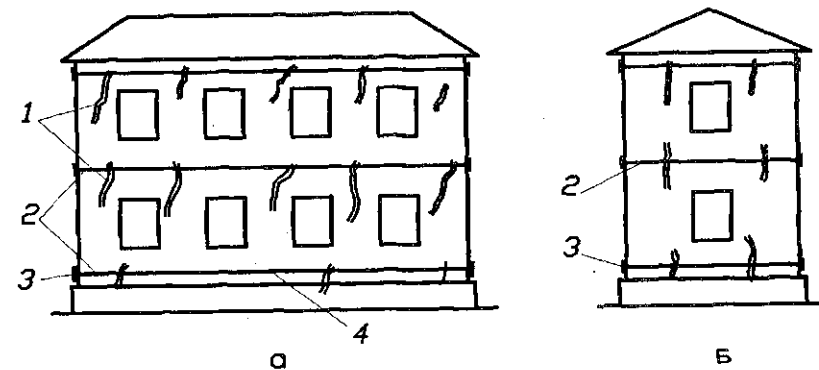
Стягивание стен здания по периметру тяжами: а — главный фасад; б — боковой фасад здания; 1 — трещины в стенах здания; 2 — тяжи; 3 — опорные уголки; 4 — стяжные муфты
